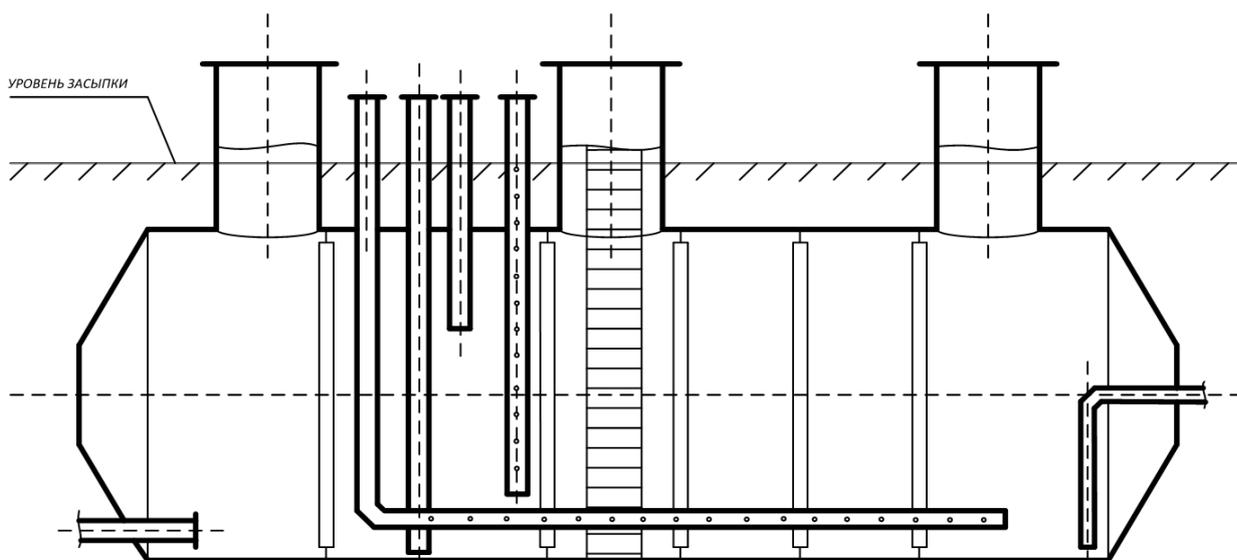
Эскиз общего вида резервуаров РГС-100
